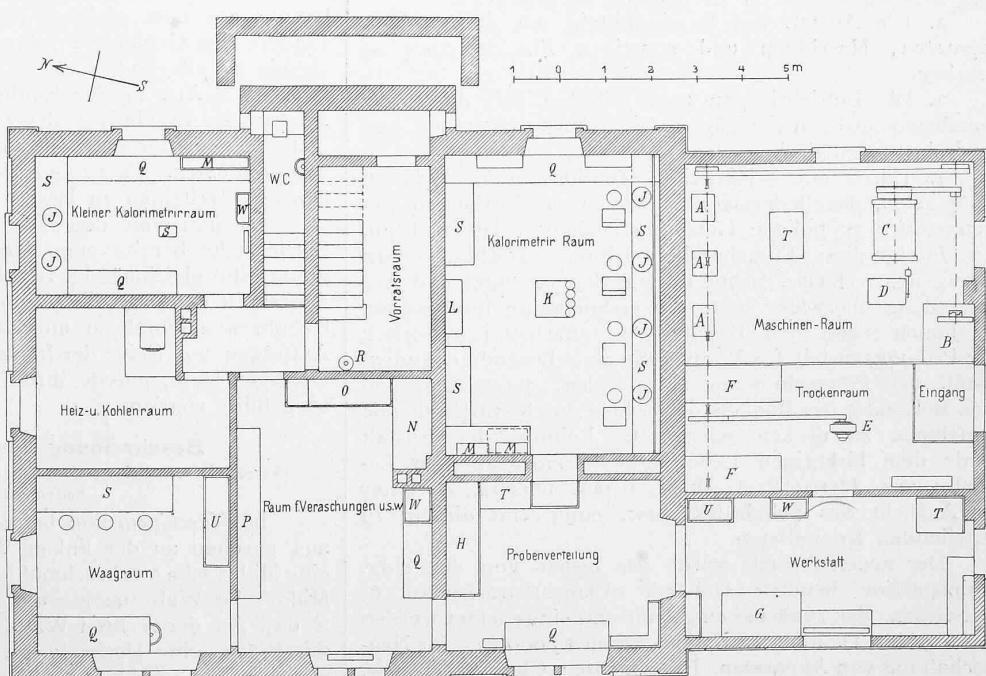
Grundriss des Erdgeschosses. — Masstab 1:150.
